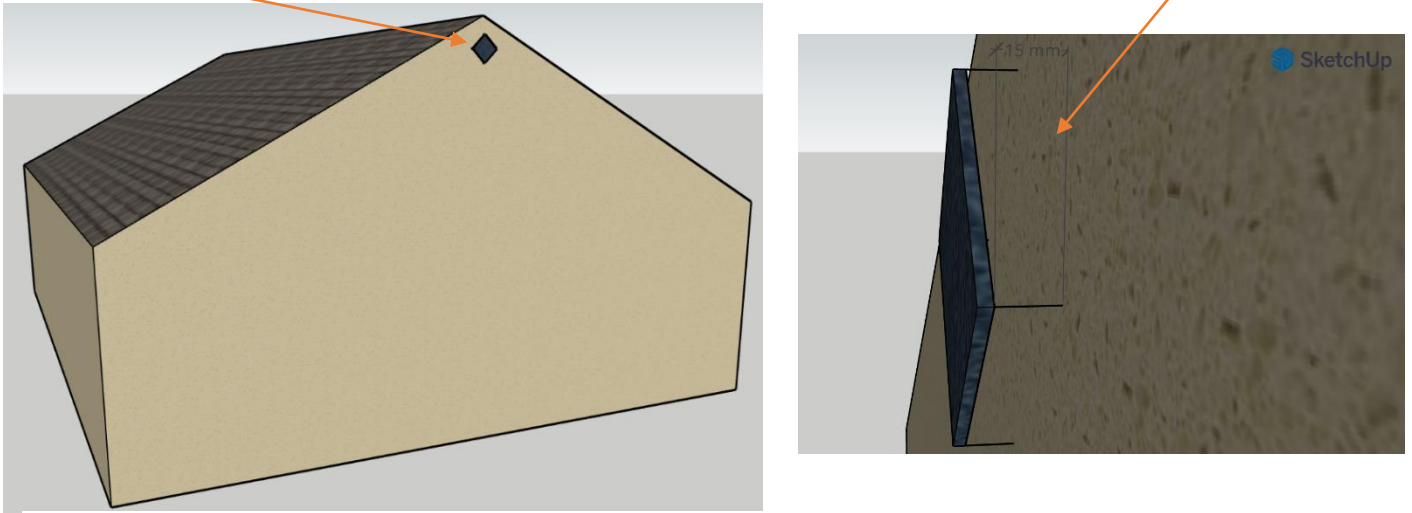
PRINCIPE D'INSTALLATION D'UNE ARDOISE DE THERMOREGULATION POUR LE LEZARD DES MURAILLES
